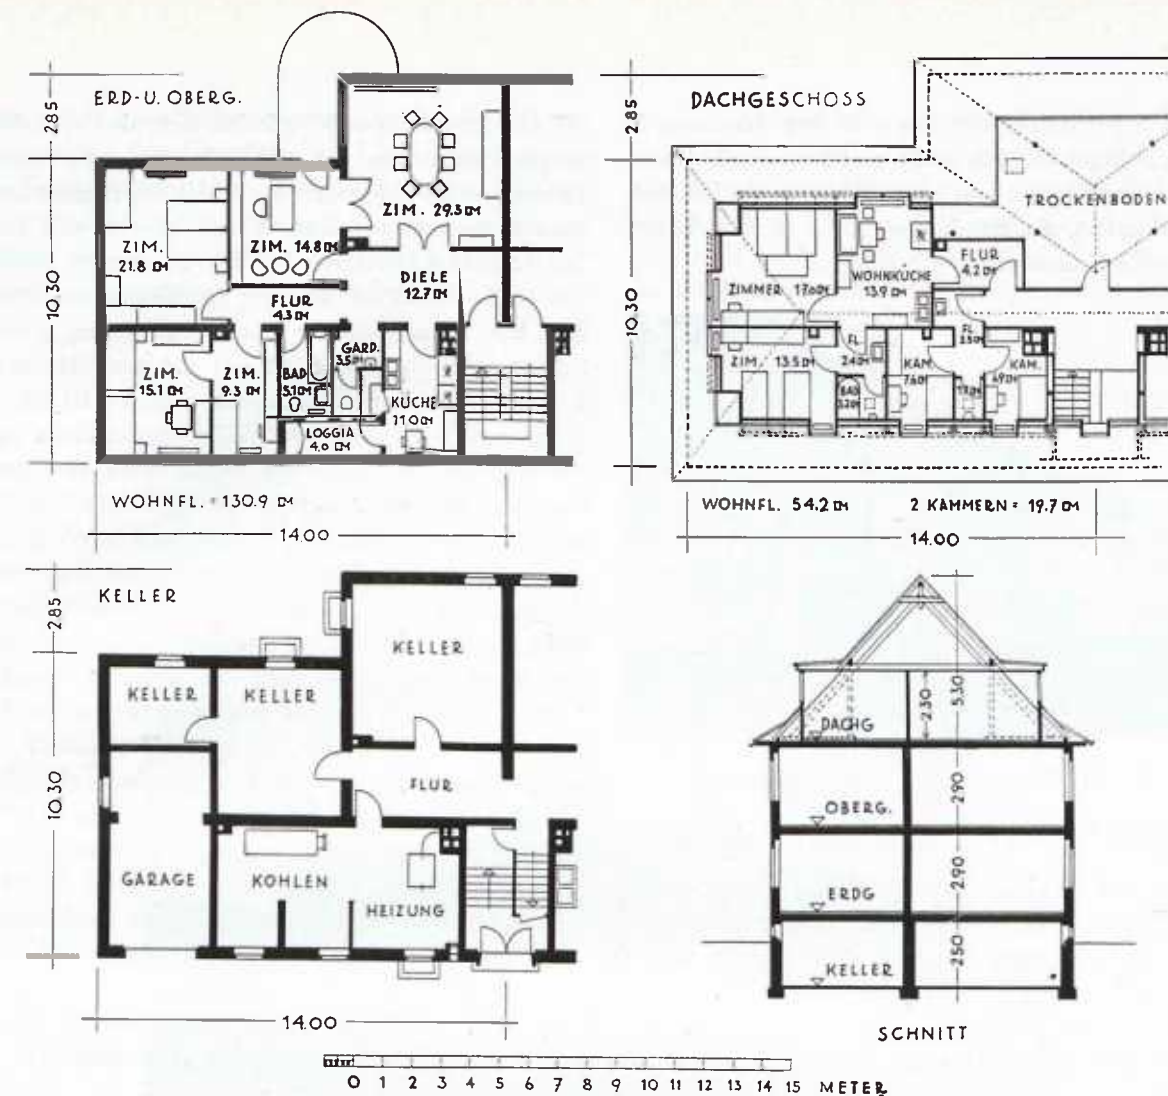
Wohnungsbauten Hultschiner Straße, Bau 1. Grundrisse und Schnitt
